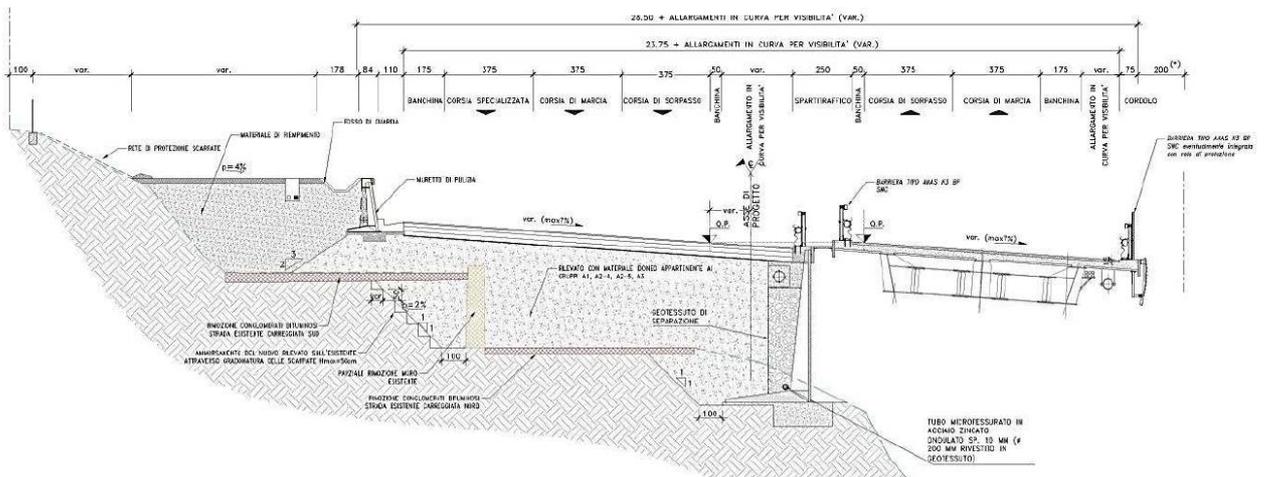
Sezione tipo B con una carreggiata in viadotto
